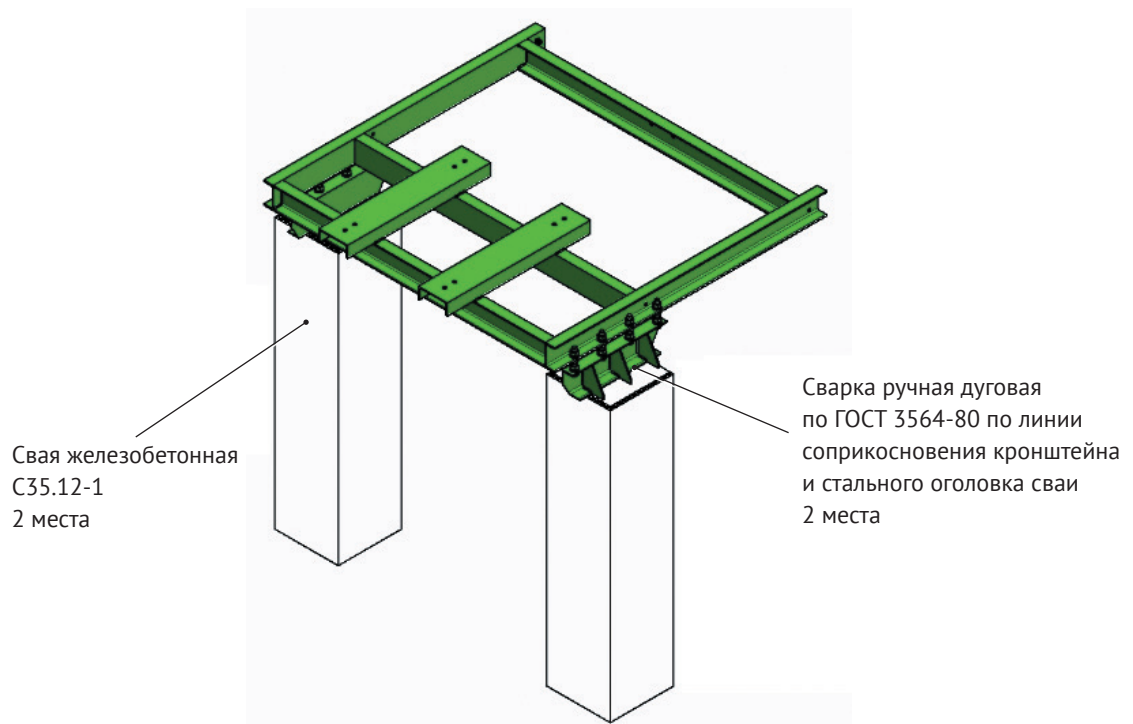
Крепление сваркой рамы монтажной к оголовкам свай типа С35
